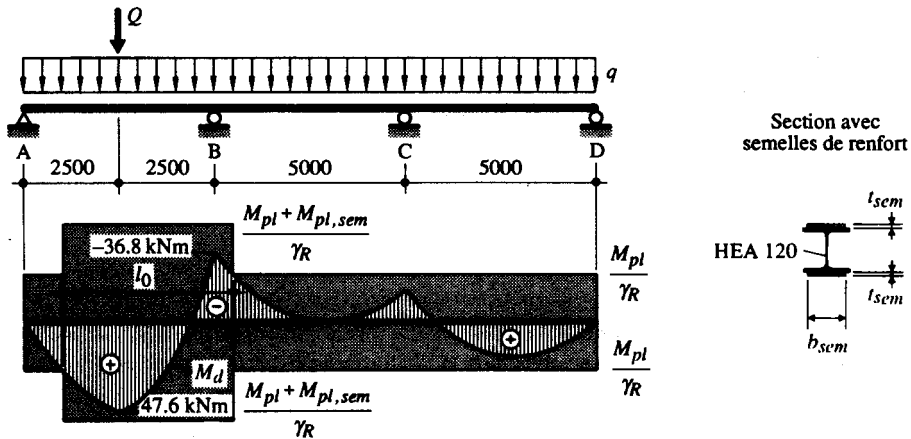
Poutre continue constituée d'un profilé avec semelles de renfort.
